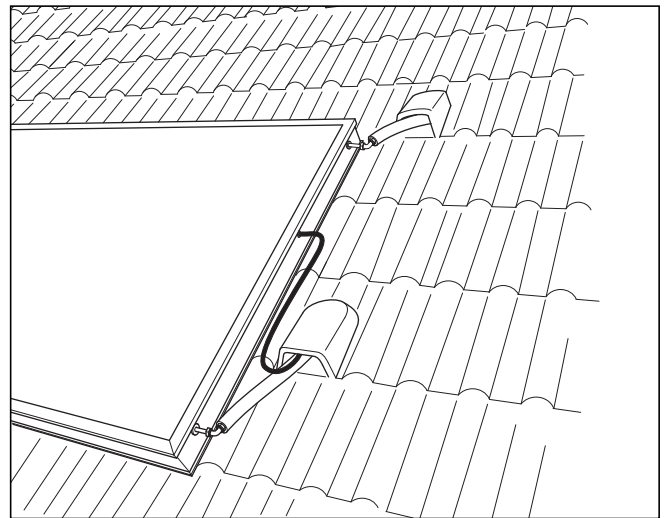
Vue d'un capteur plan auroTHERM lors d'un montage sur toiture
